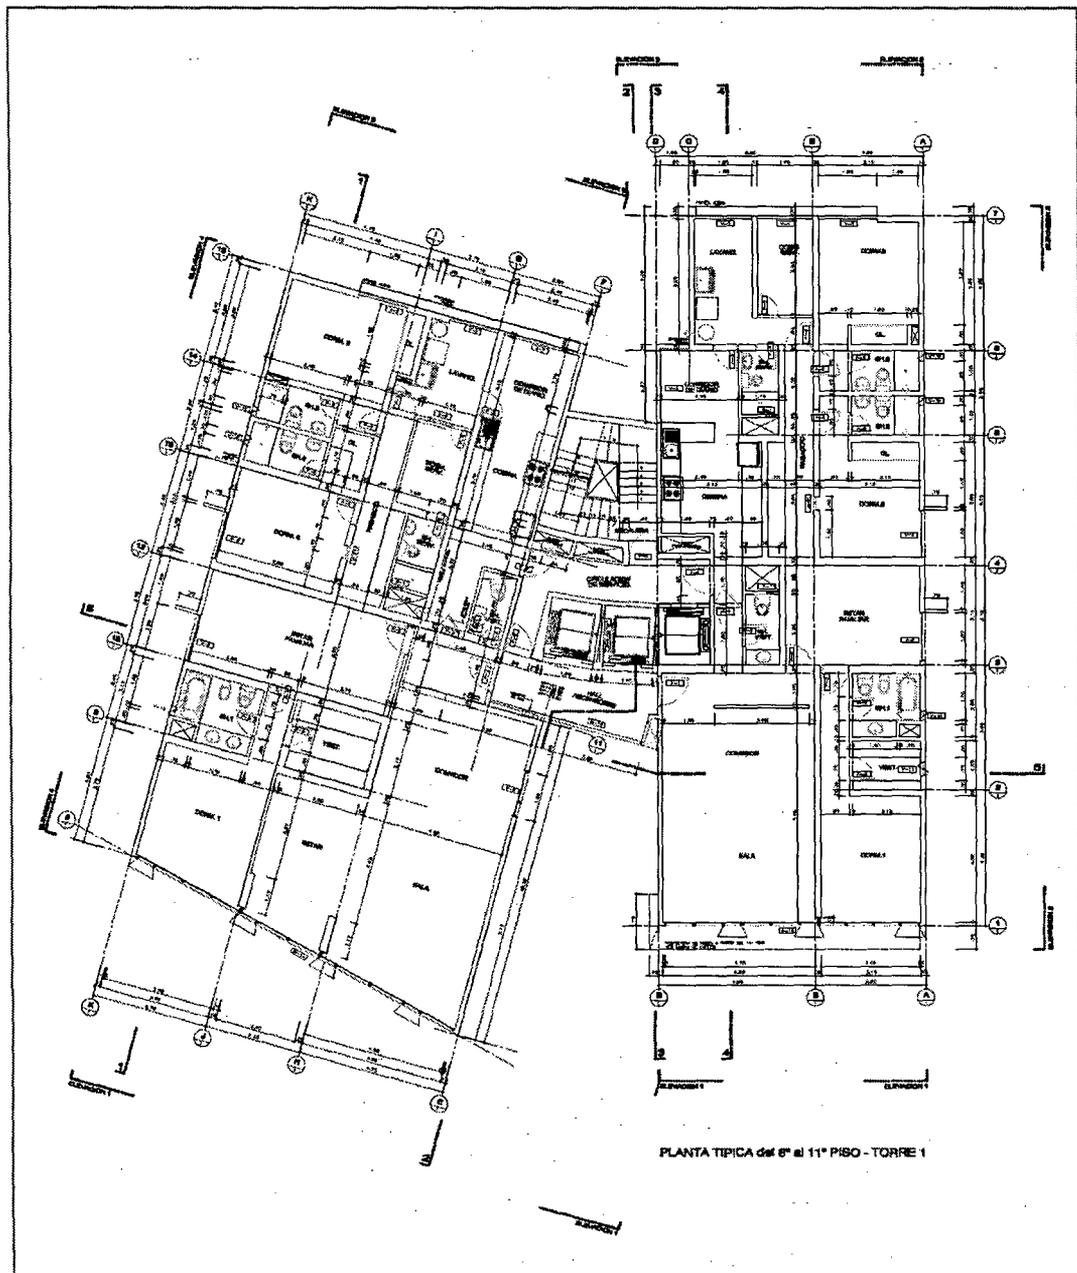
Planta Típica Torre 1 del proyecto Golf Millenium
